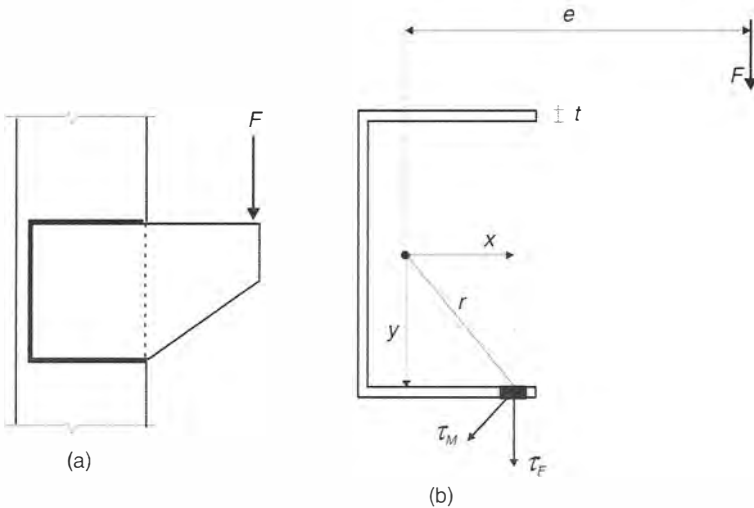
Ligação soldada com carga cisalhante excêntrica: (a) esquema da ligação; (b) área de cálculo do cordão de solda, obtida por rebatimento da garganta sobre o plano da chapa. Admite-se que o eixo do cordão de solda coincide com as bordas da chapa.
